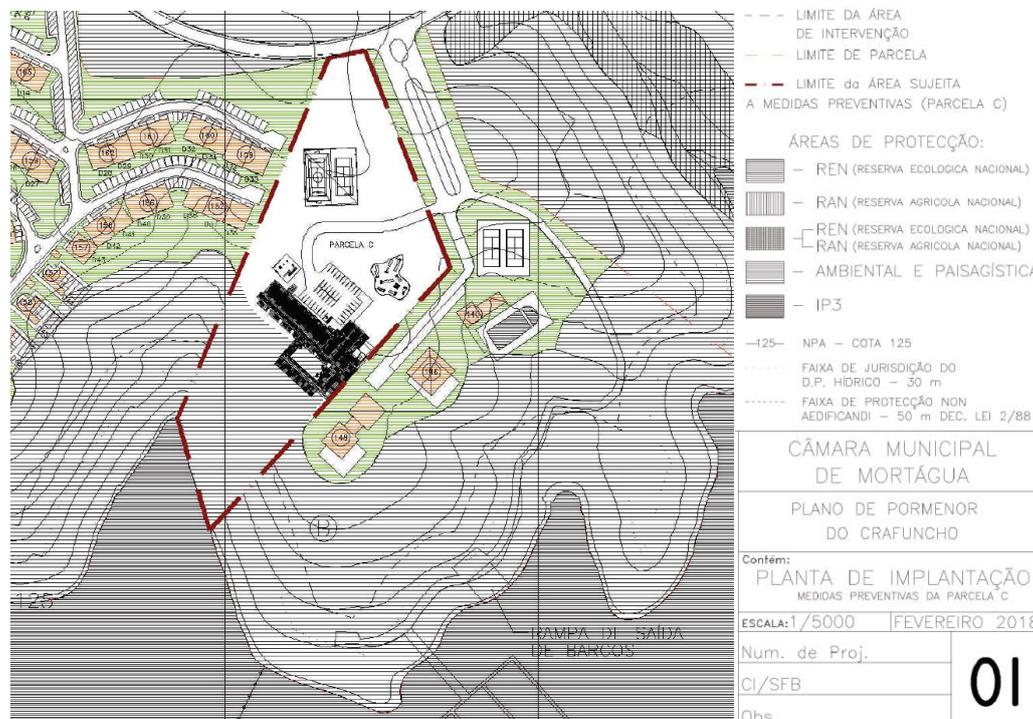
Extrato da Planta de Implantação da área sujeita a suspensão, 2018
